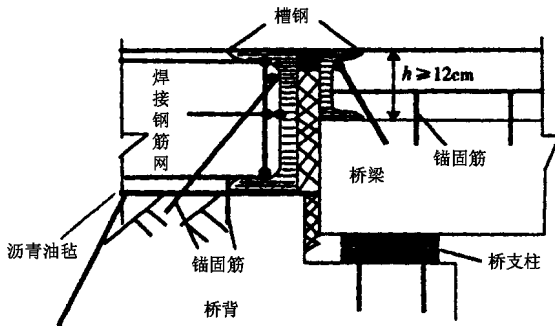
桥台上部钢筋混凝土桥面与搭板之间加强Ⅲ胀缝
